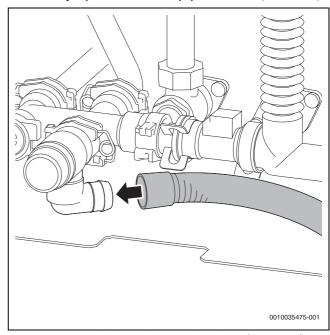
Montage du tube sur la soupape de sécurité (circuit ECS)
